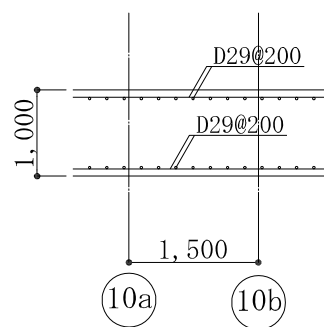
基礎スラブの配筋図 (1A 通り, 単位: mm)
